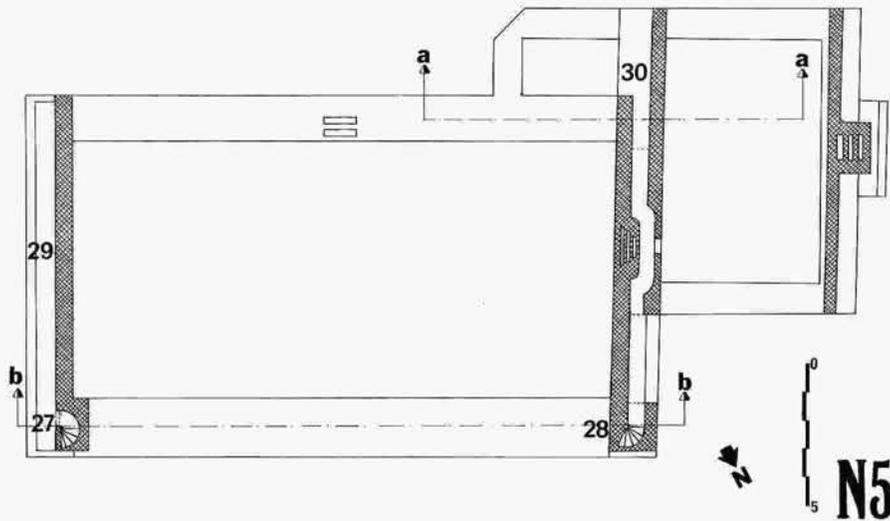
PLAN DES BÂTIMENTS DU « DONJON » AU NIVEAU 5,
